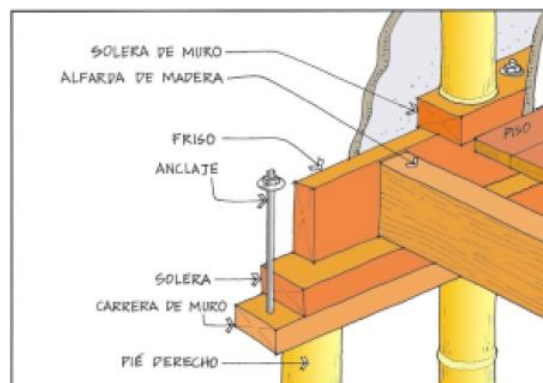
Detalle de entrepiso con vigas de Guadua
